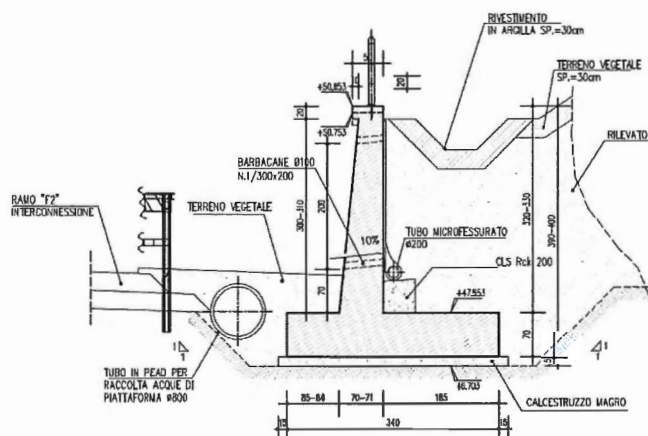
Sezione Tipo - Muro 3 Concio 3
